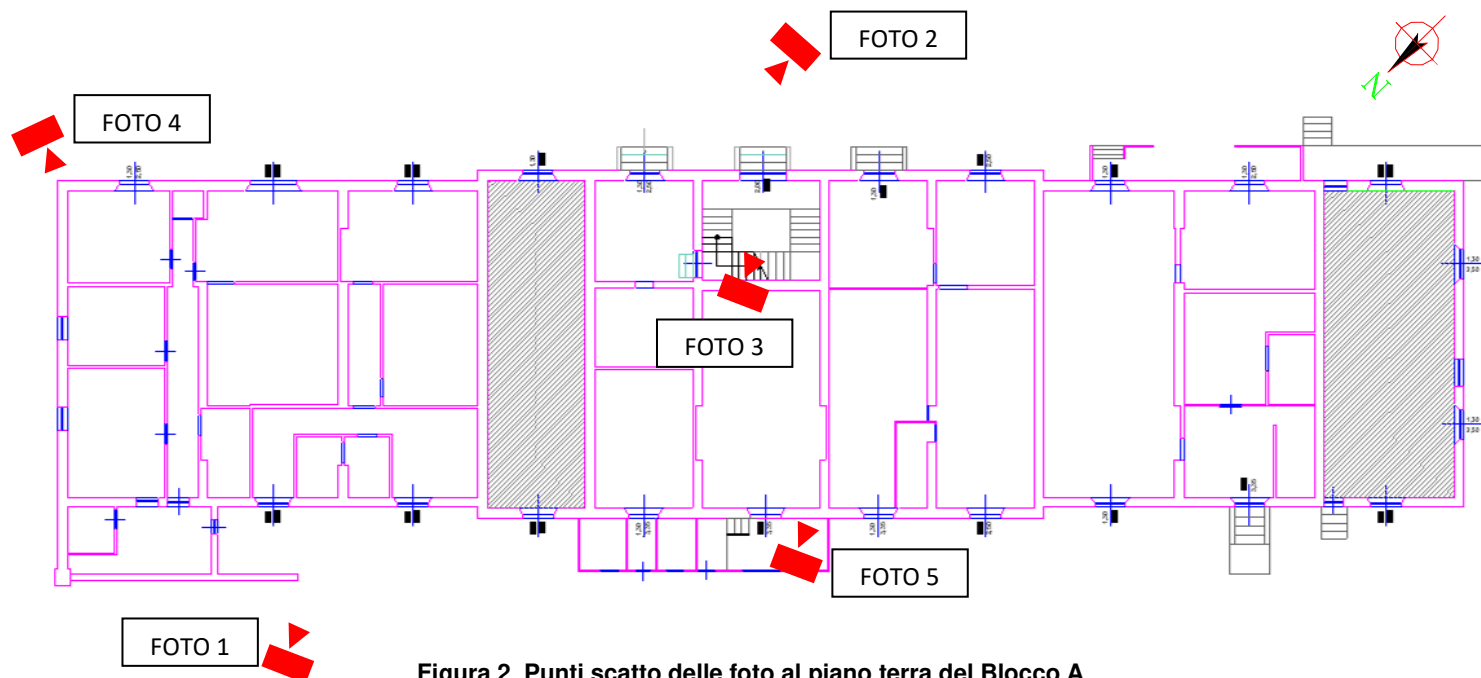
Punti scatto delle foto al piano terra del Blocco A
